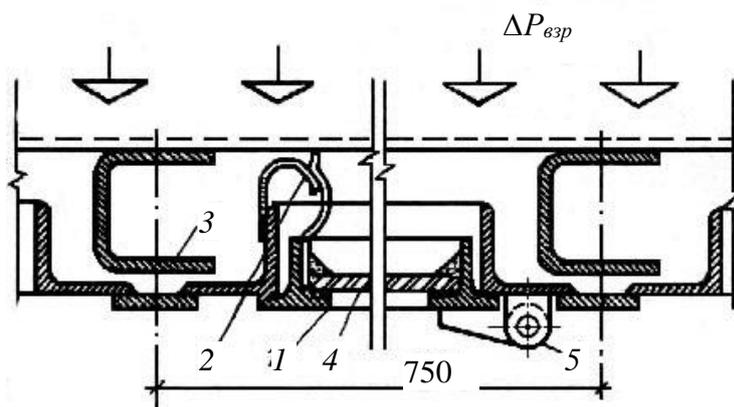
Разрез оконной рамы с открывающимся переплетом с вертикальным шарниром:
